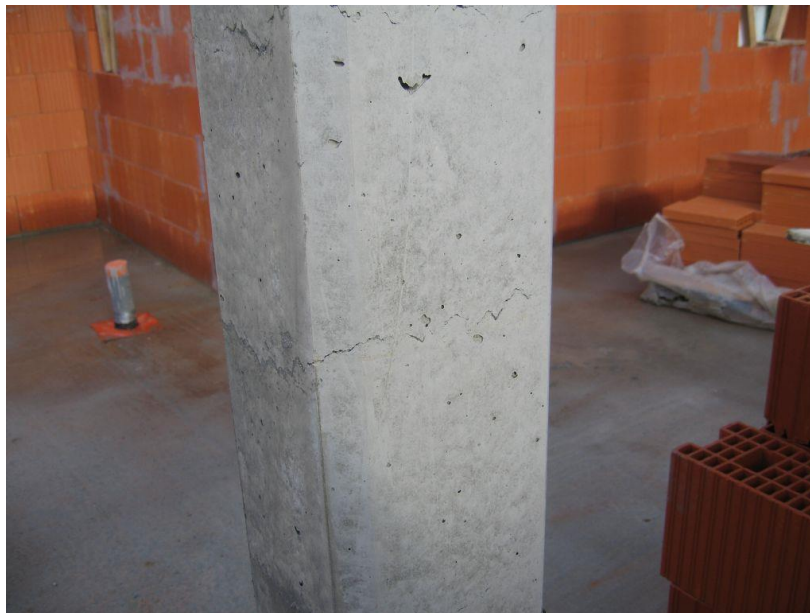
Poteau endommagé à cause d'une agression au chantier.
